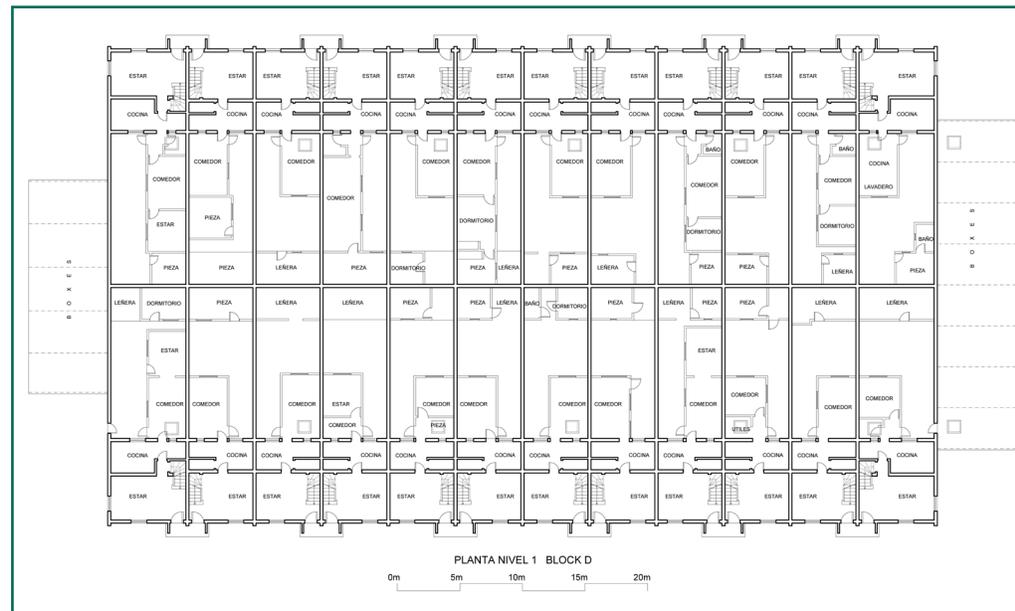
Planta Pabellón D, piso 1, colectivos para empleados y operarios solteros (fuente: P. Miranda).
